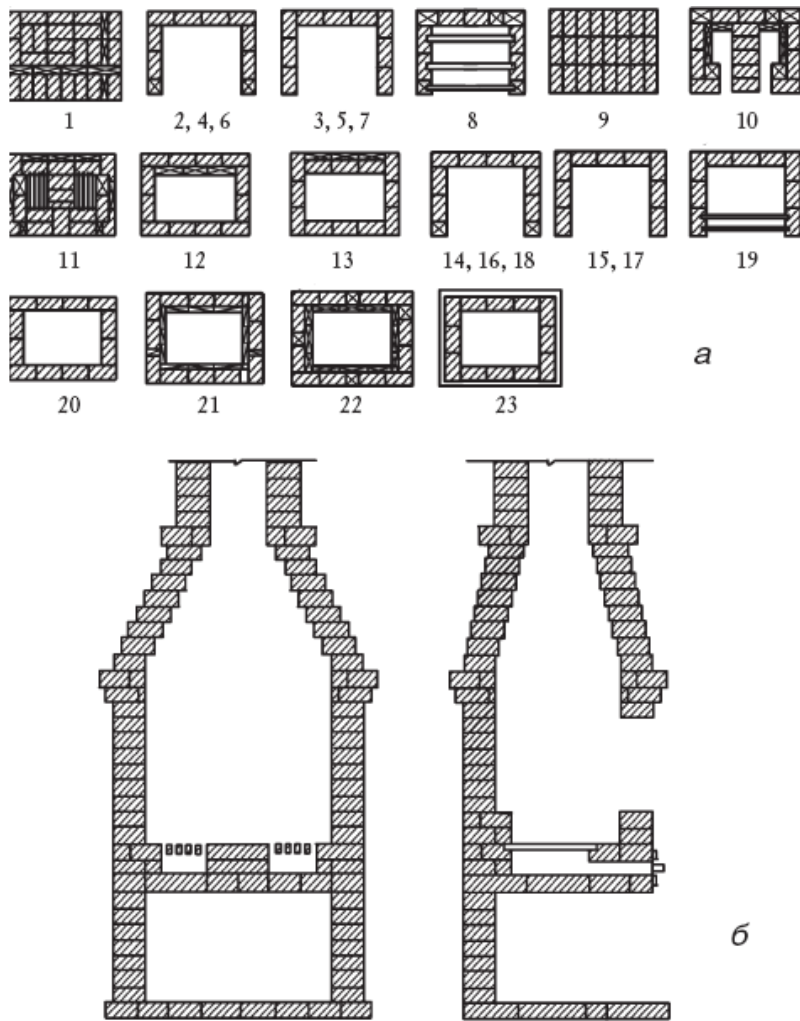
Конструкция камина: а – порядовка; б – разрезы
